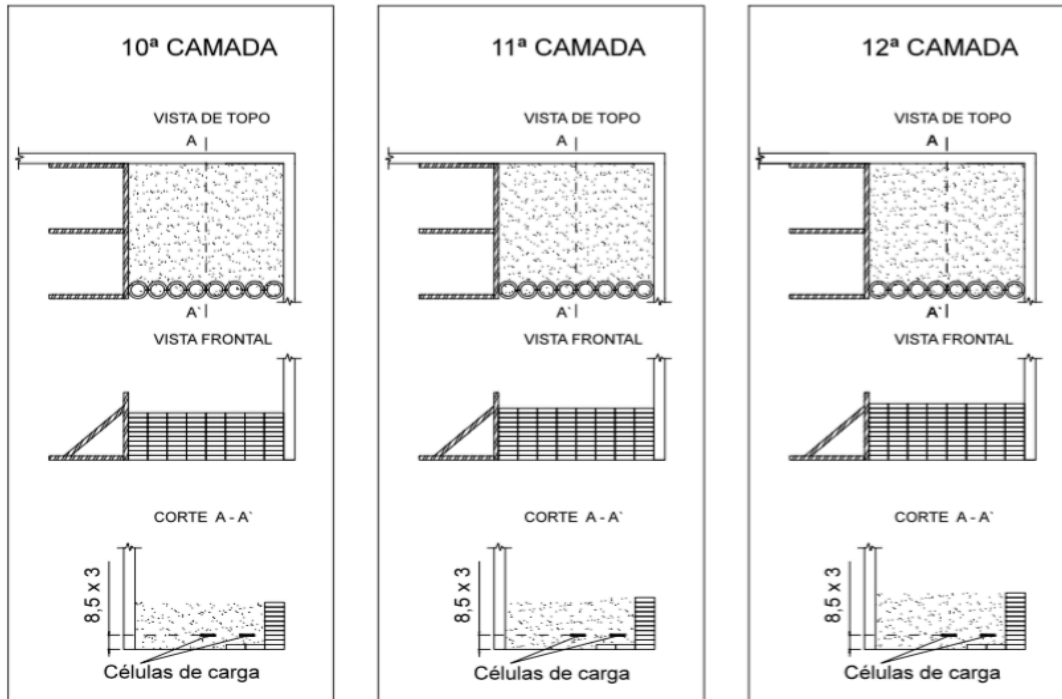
Faseamento construtivo da 10ª à 12ª camada.
